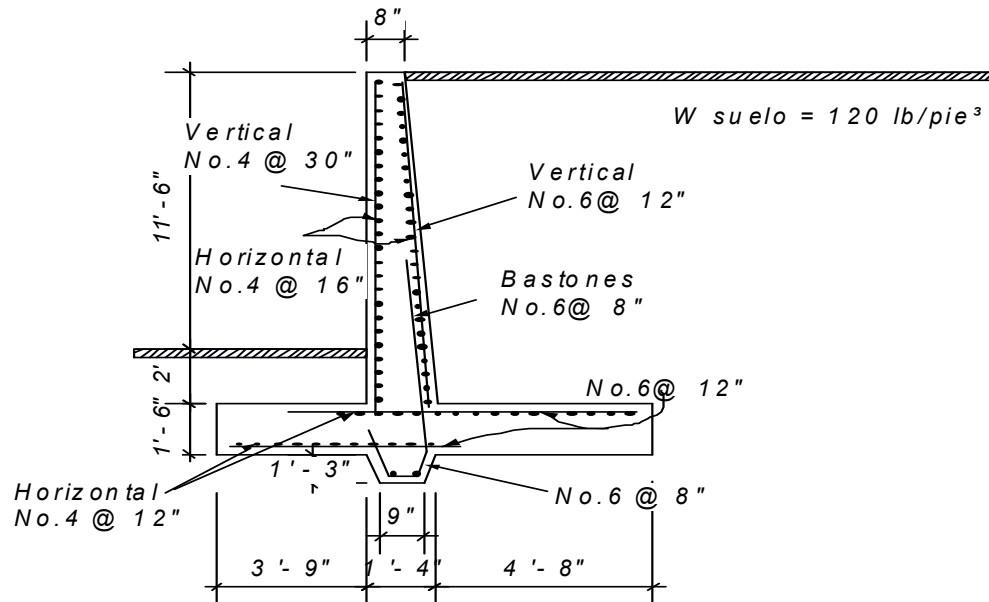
Sección de muro, sistema tradicional de hormigón armado
